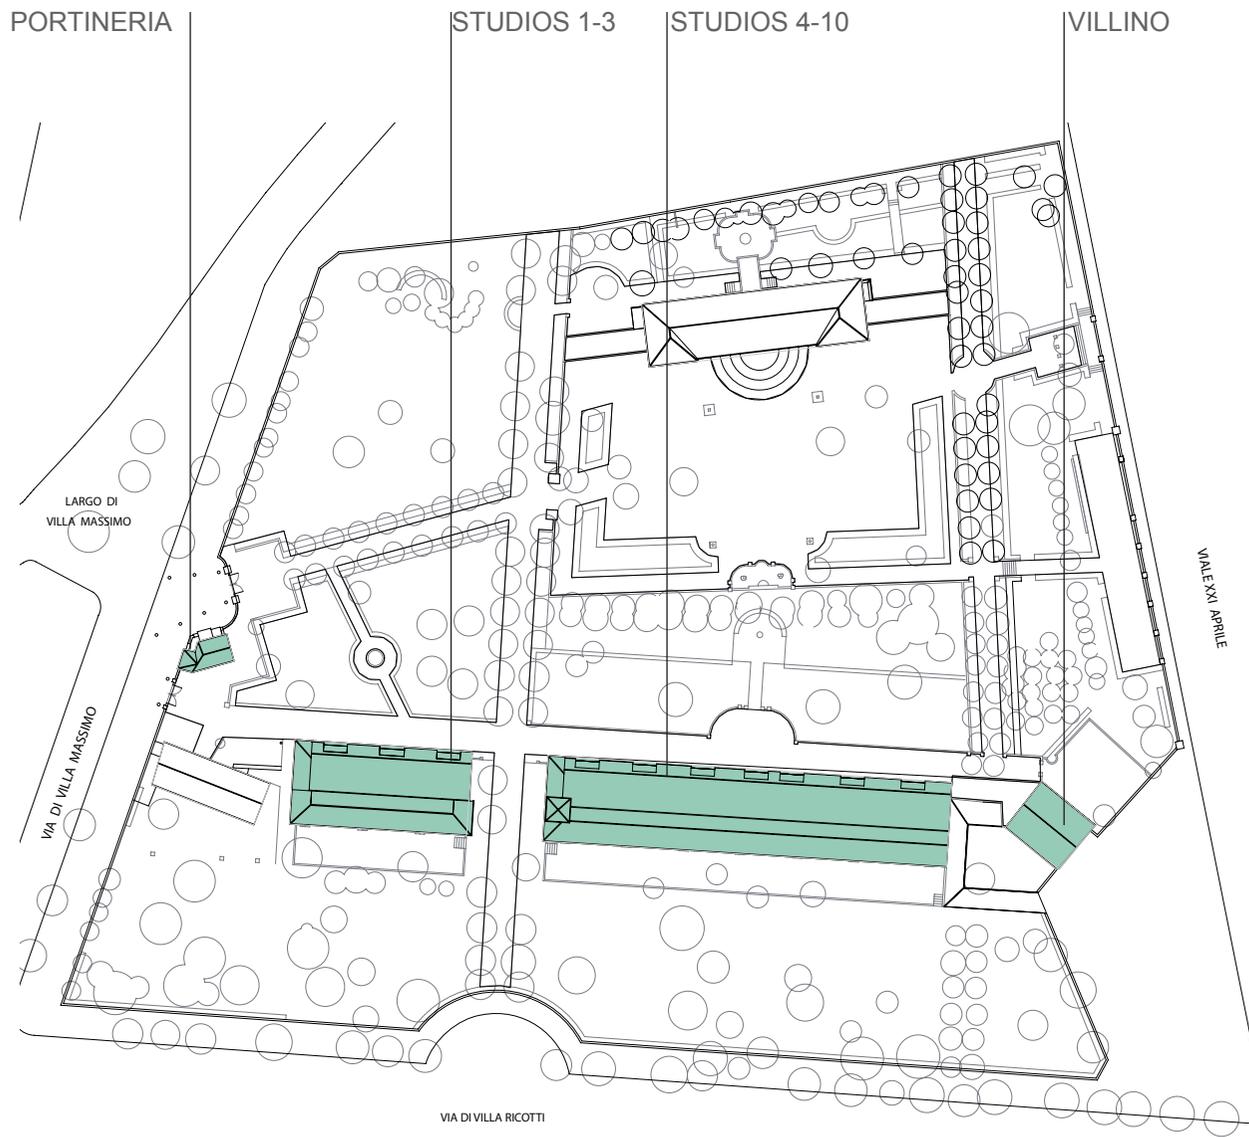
Lageplan Villino / Studios / Portineria
